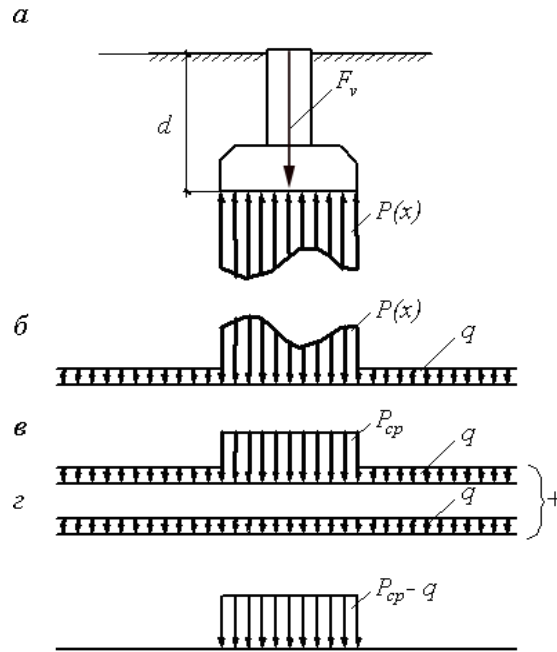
Схемы к действию нагрузок на основание фундамента
